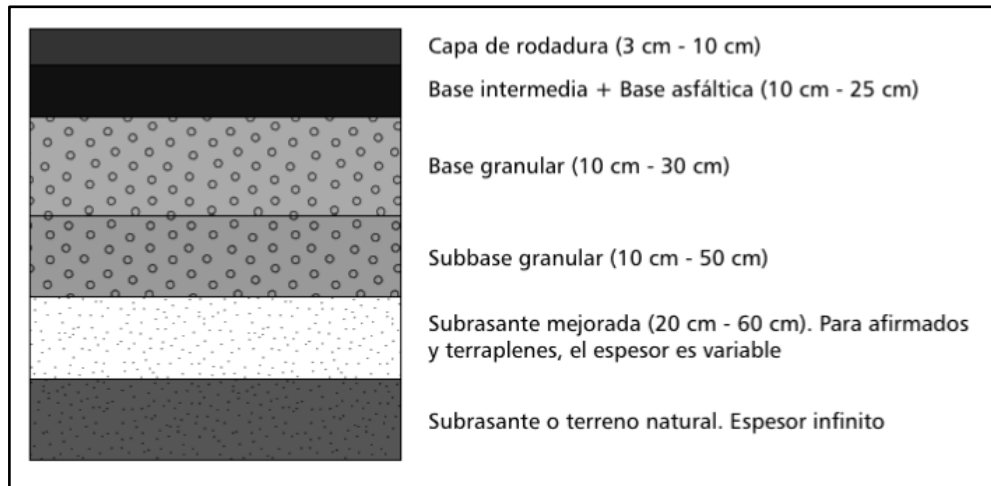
Perfil típico de la estructura de un pavimento flexible.
